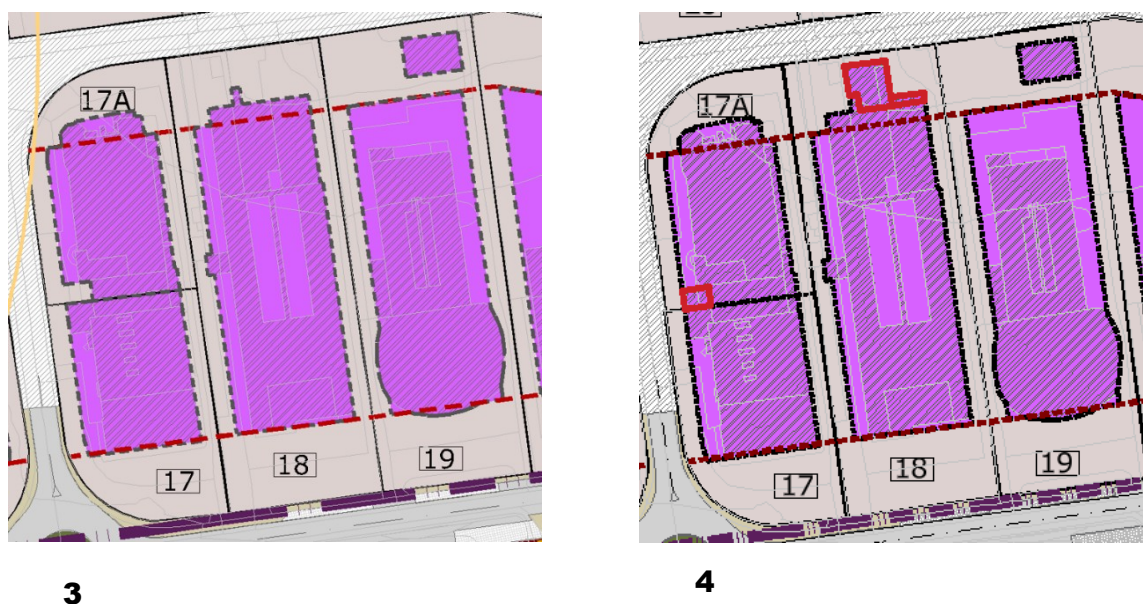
3. Extrato da planta de implantação do PPZIOH em vigor e 4. Representação das alterações a introduzir nos lotes 17ª e 18
